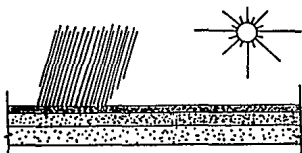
Falla de un pavimento por la equivocada selección de los materiales.
